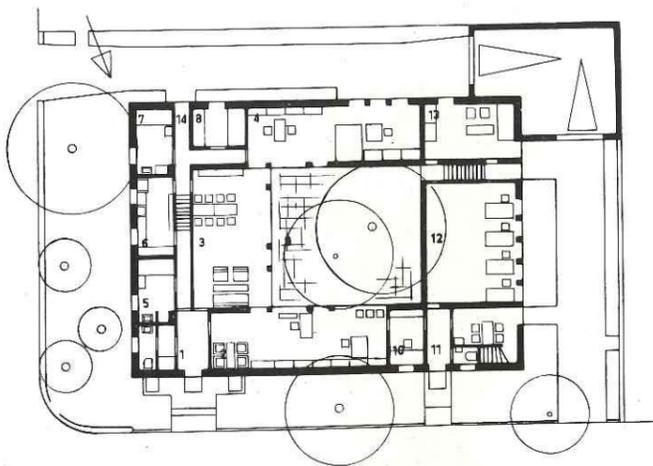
Grundriß Atriumhaus Prof. Schwippert
